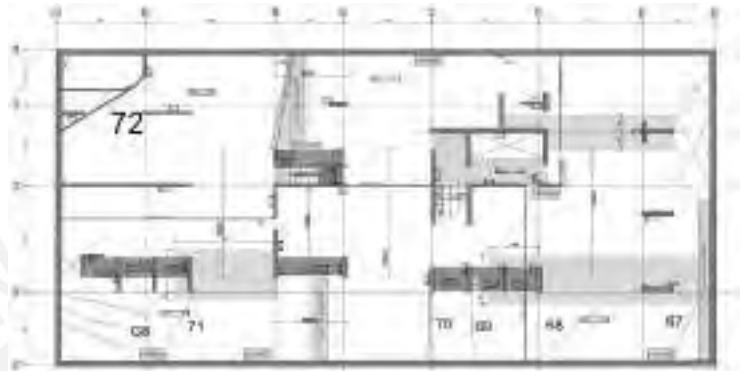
Grupo de Fisuras G8 (3)
